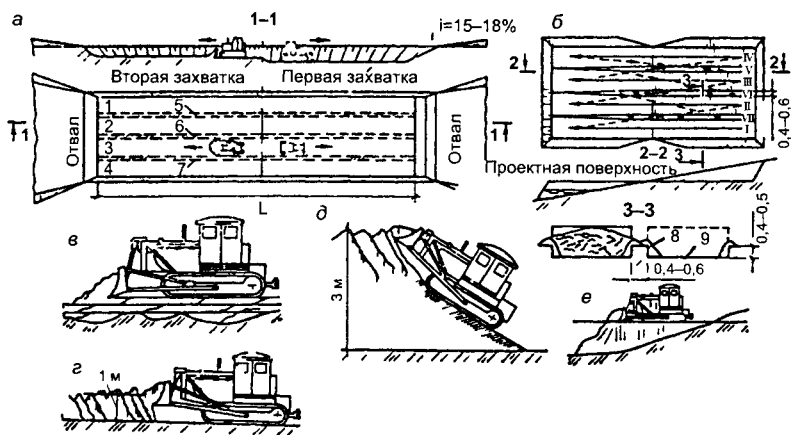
Способы и схемы разработки грунта бульдозерами:
